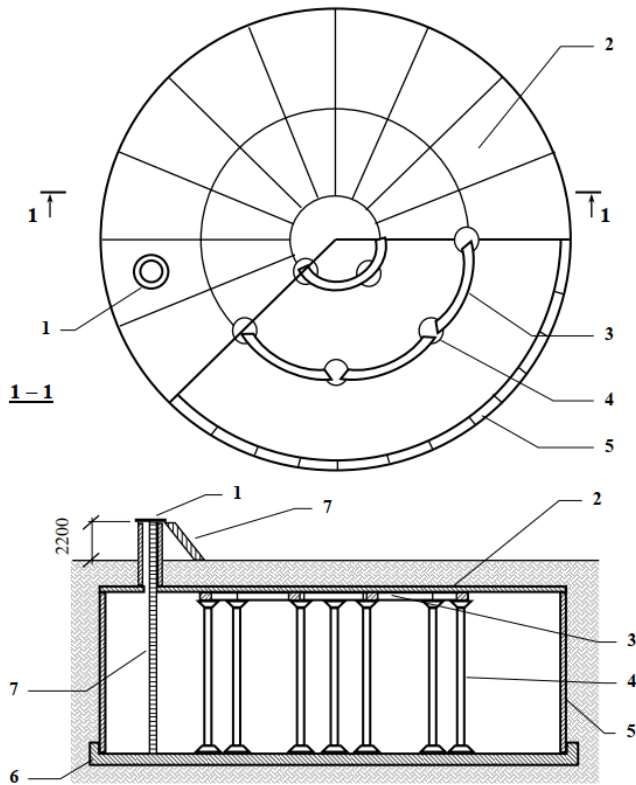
Залізобетонний збірний підземний резервуар: 1 – люк-лаз; 2 – трапецієдальні панелі; 3 – кільцева балка; 4 – опора; 5 – стінові панелі; 6 – фундамент; 7 – драбина
